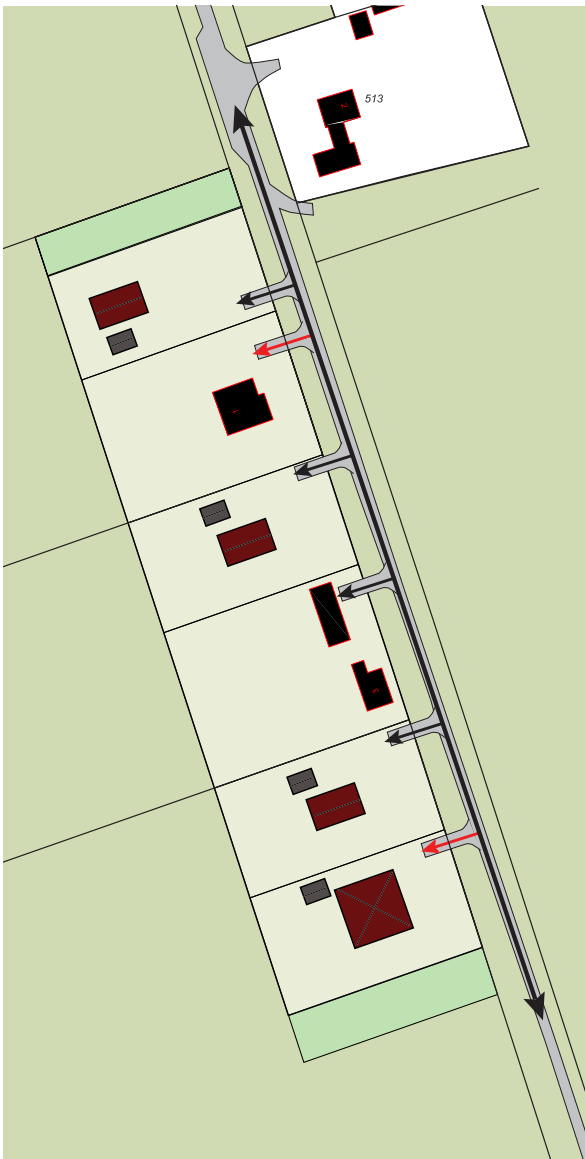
Doorzicht op het open achterliggende landschap en uitzicht vanaf woonkavels
